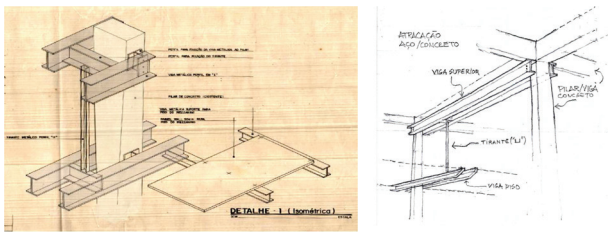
| Esquema e croqui da estrutura (atracação aço/concreto)
